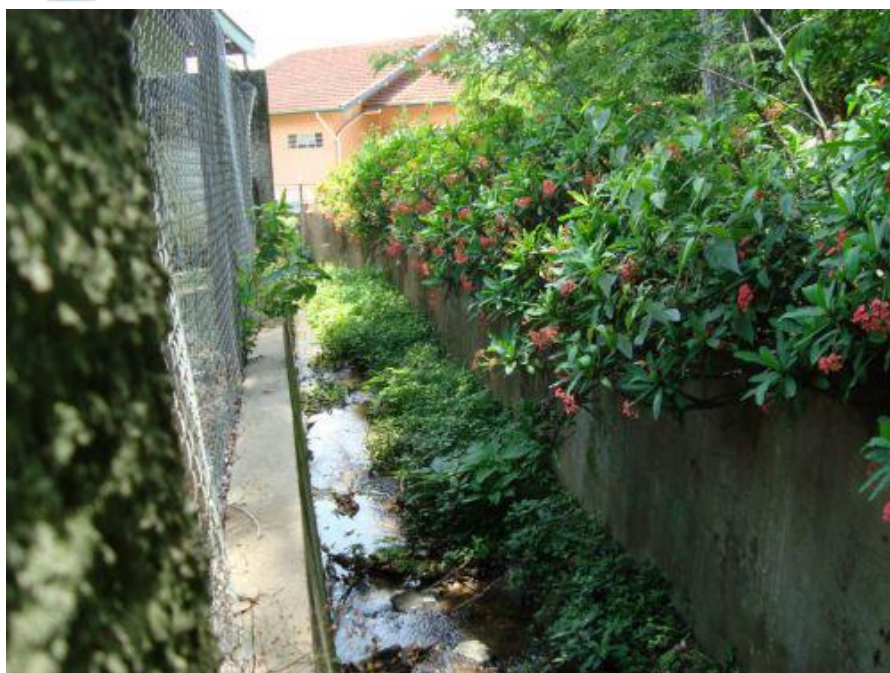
Canal de concreto à montante da passagem sob a Rua Adelaide Azevedo e Mello
